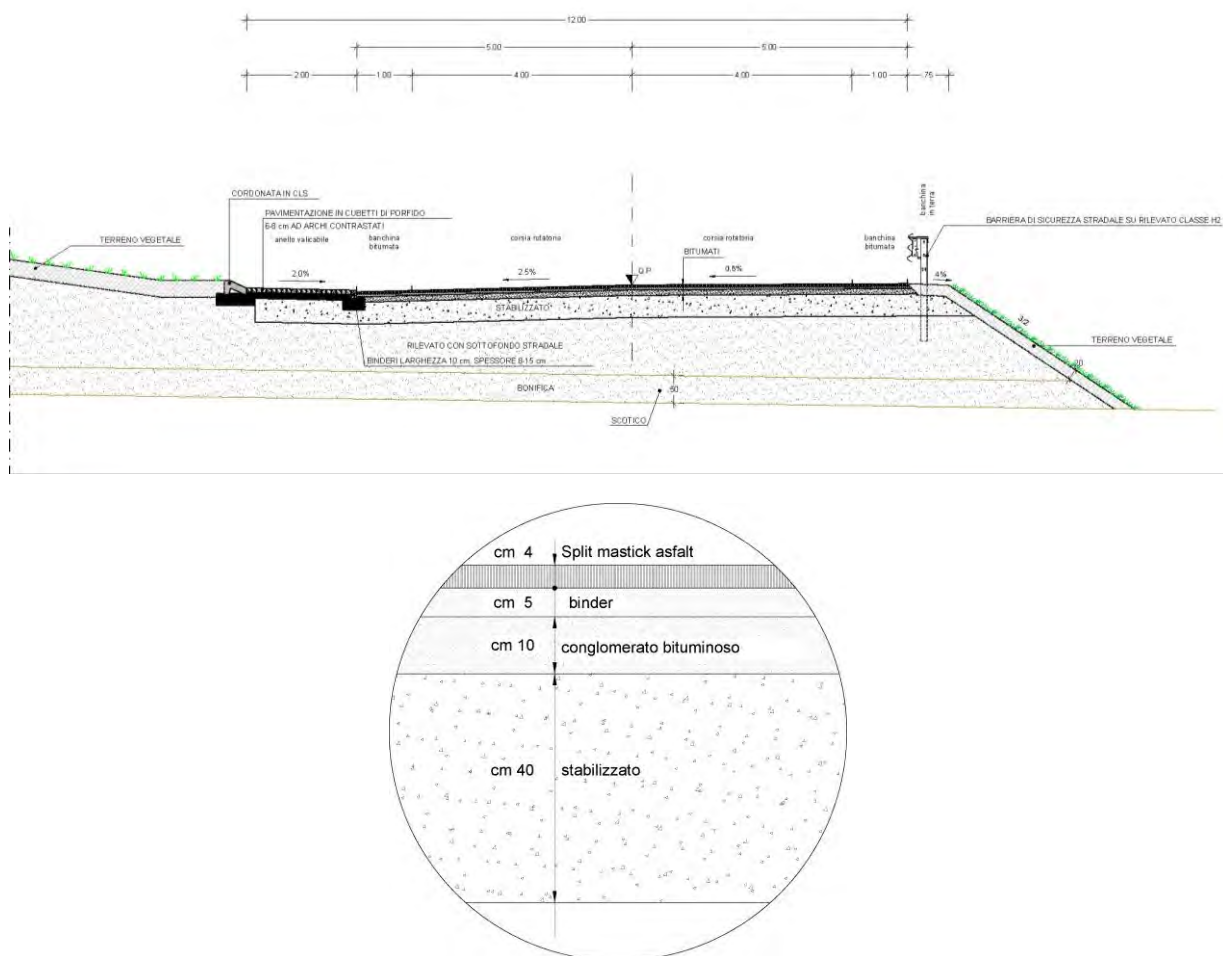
Sezione tipo rotatoria e pacchetto stradale
